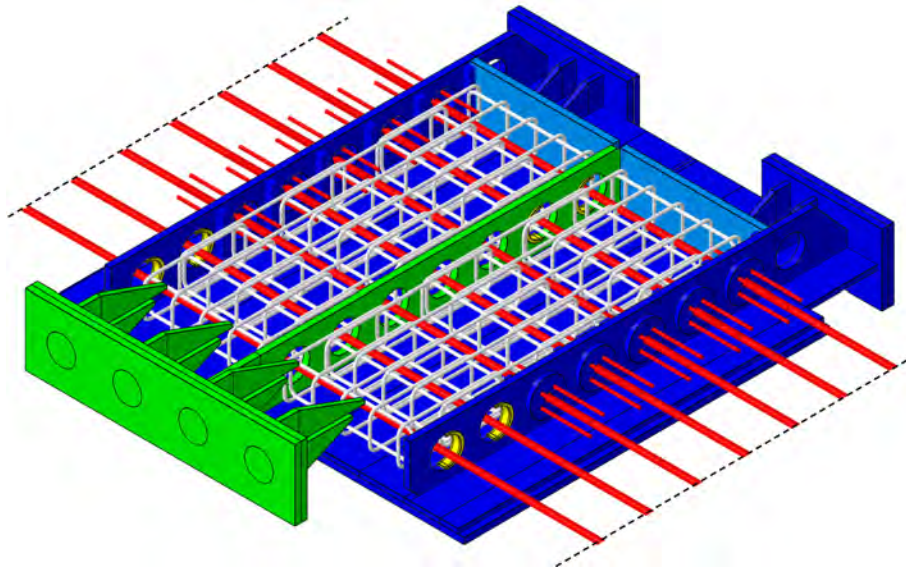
Versuchskörper VK1/5, mit Zug, mit Längs- und Bügelbewehrung und Stützblech
